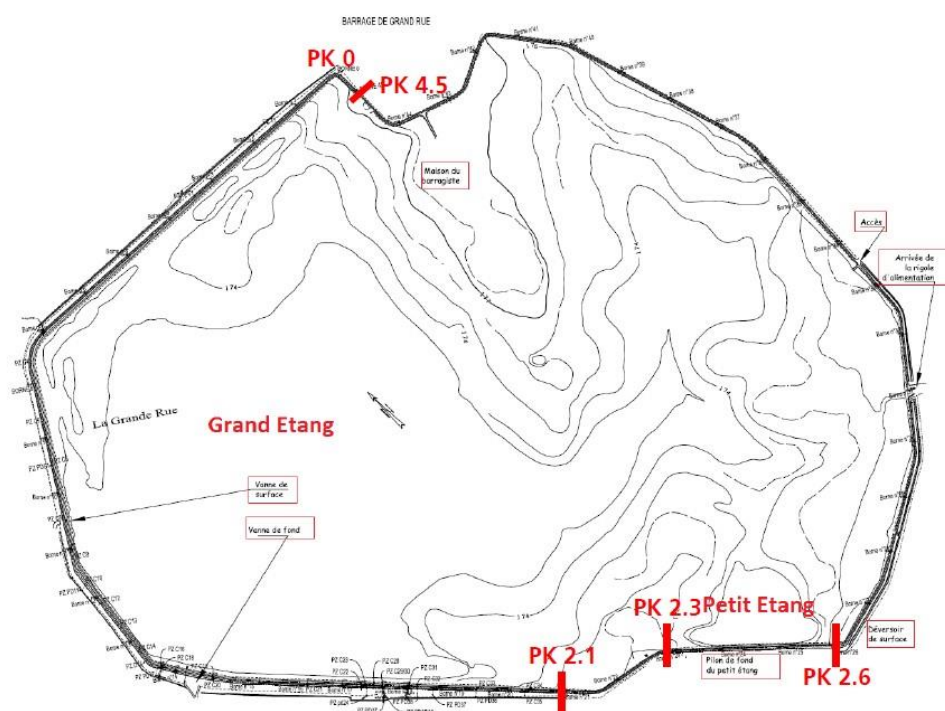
Vue en plan du barrage de Grand Rue (Source : dossier)
